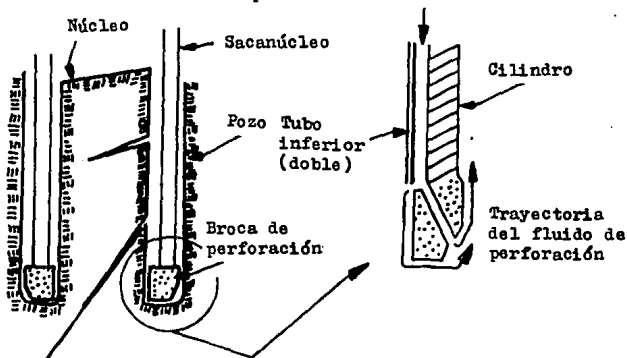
Sacanúcleo con doble tubo que impide que el fluido de perforación tenga contacto innecesario con el núcleo mientras este se encuentra en el sacanúcleo.
